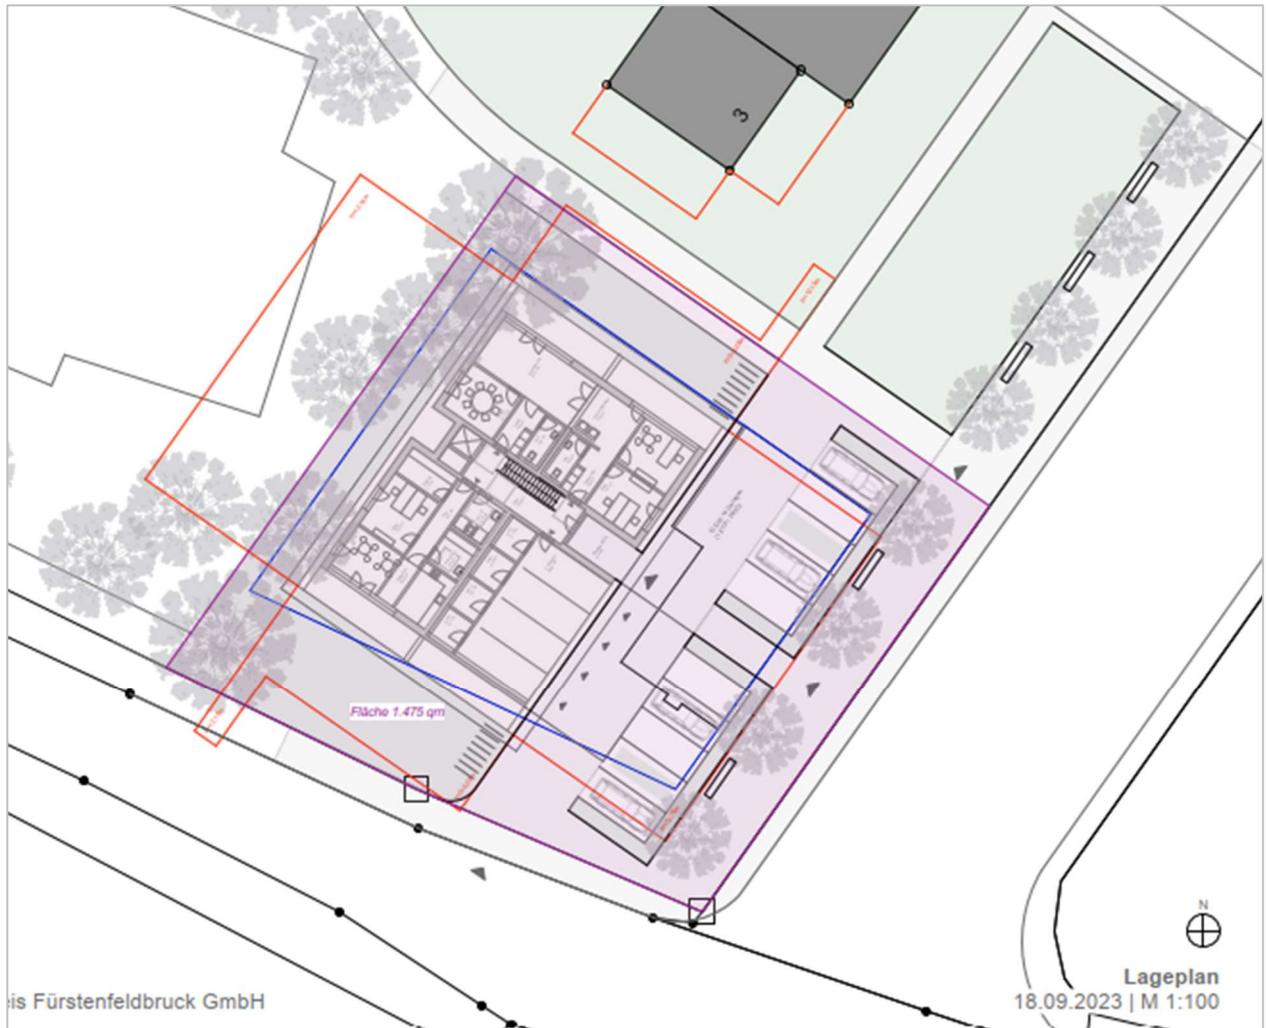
Lageplan (Konzept Kammerl und Kollegen, Stand 18.09.2023)
